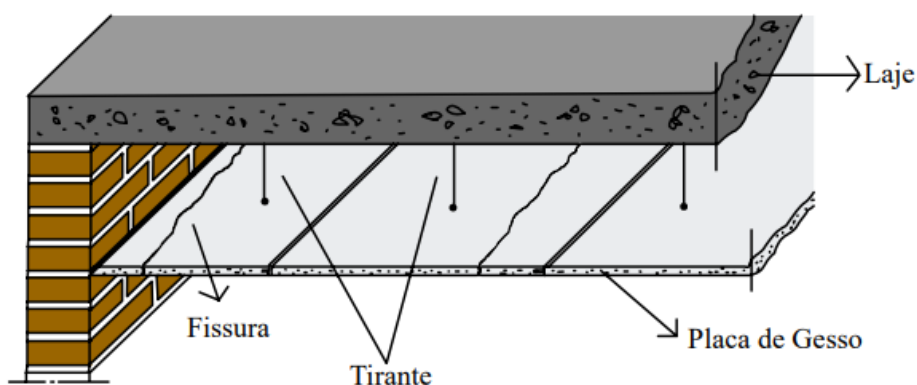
Fissuração de placas de gesso em forro rigidamente encunhado nas paredes (SOUZA M. F., 2008).
